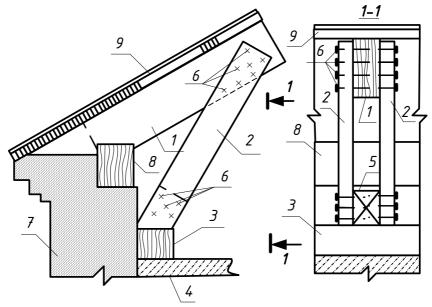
Установка подкосов, опирающихся на перекрытие: 1 - стропильная деревянная нога, имеющая поврежденную опорную часть; 2 - деревянные подкосы; 3 - лежень из бруса; 4 - чердачное перекрытие; 5 – прокладка; 6 – гвозди; 7 - наружная кирпичная стена; 8 – мауэрлат; 9 – обрешетка
